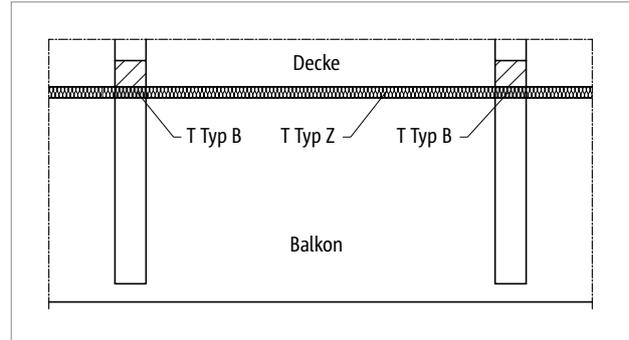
Schöck Isokorb® T Typ B: Balkonkonstruktion mit frei ausragenden Unterzügen
